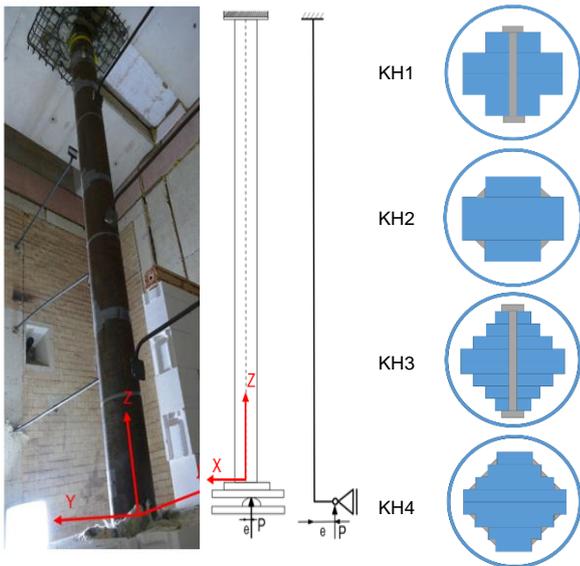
Gesamtansicht der Stütze im Ofen und Querschnitt der Stützen geschweißt, geschraubt
